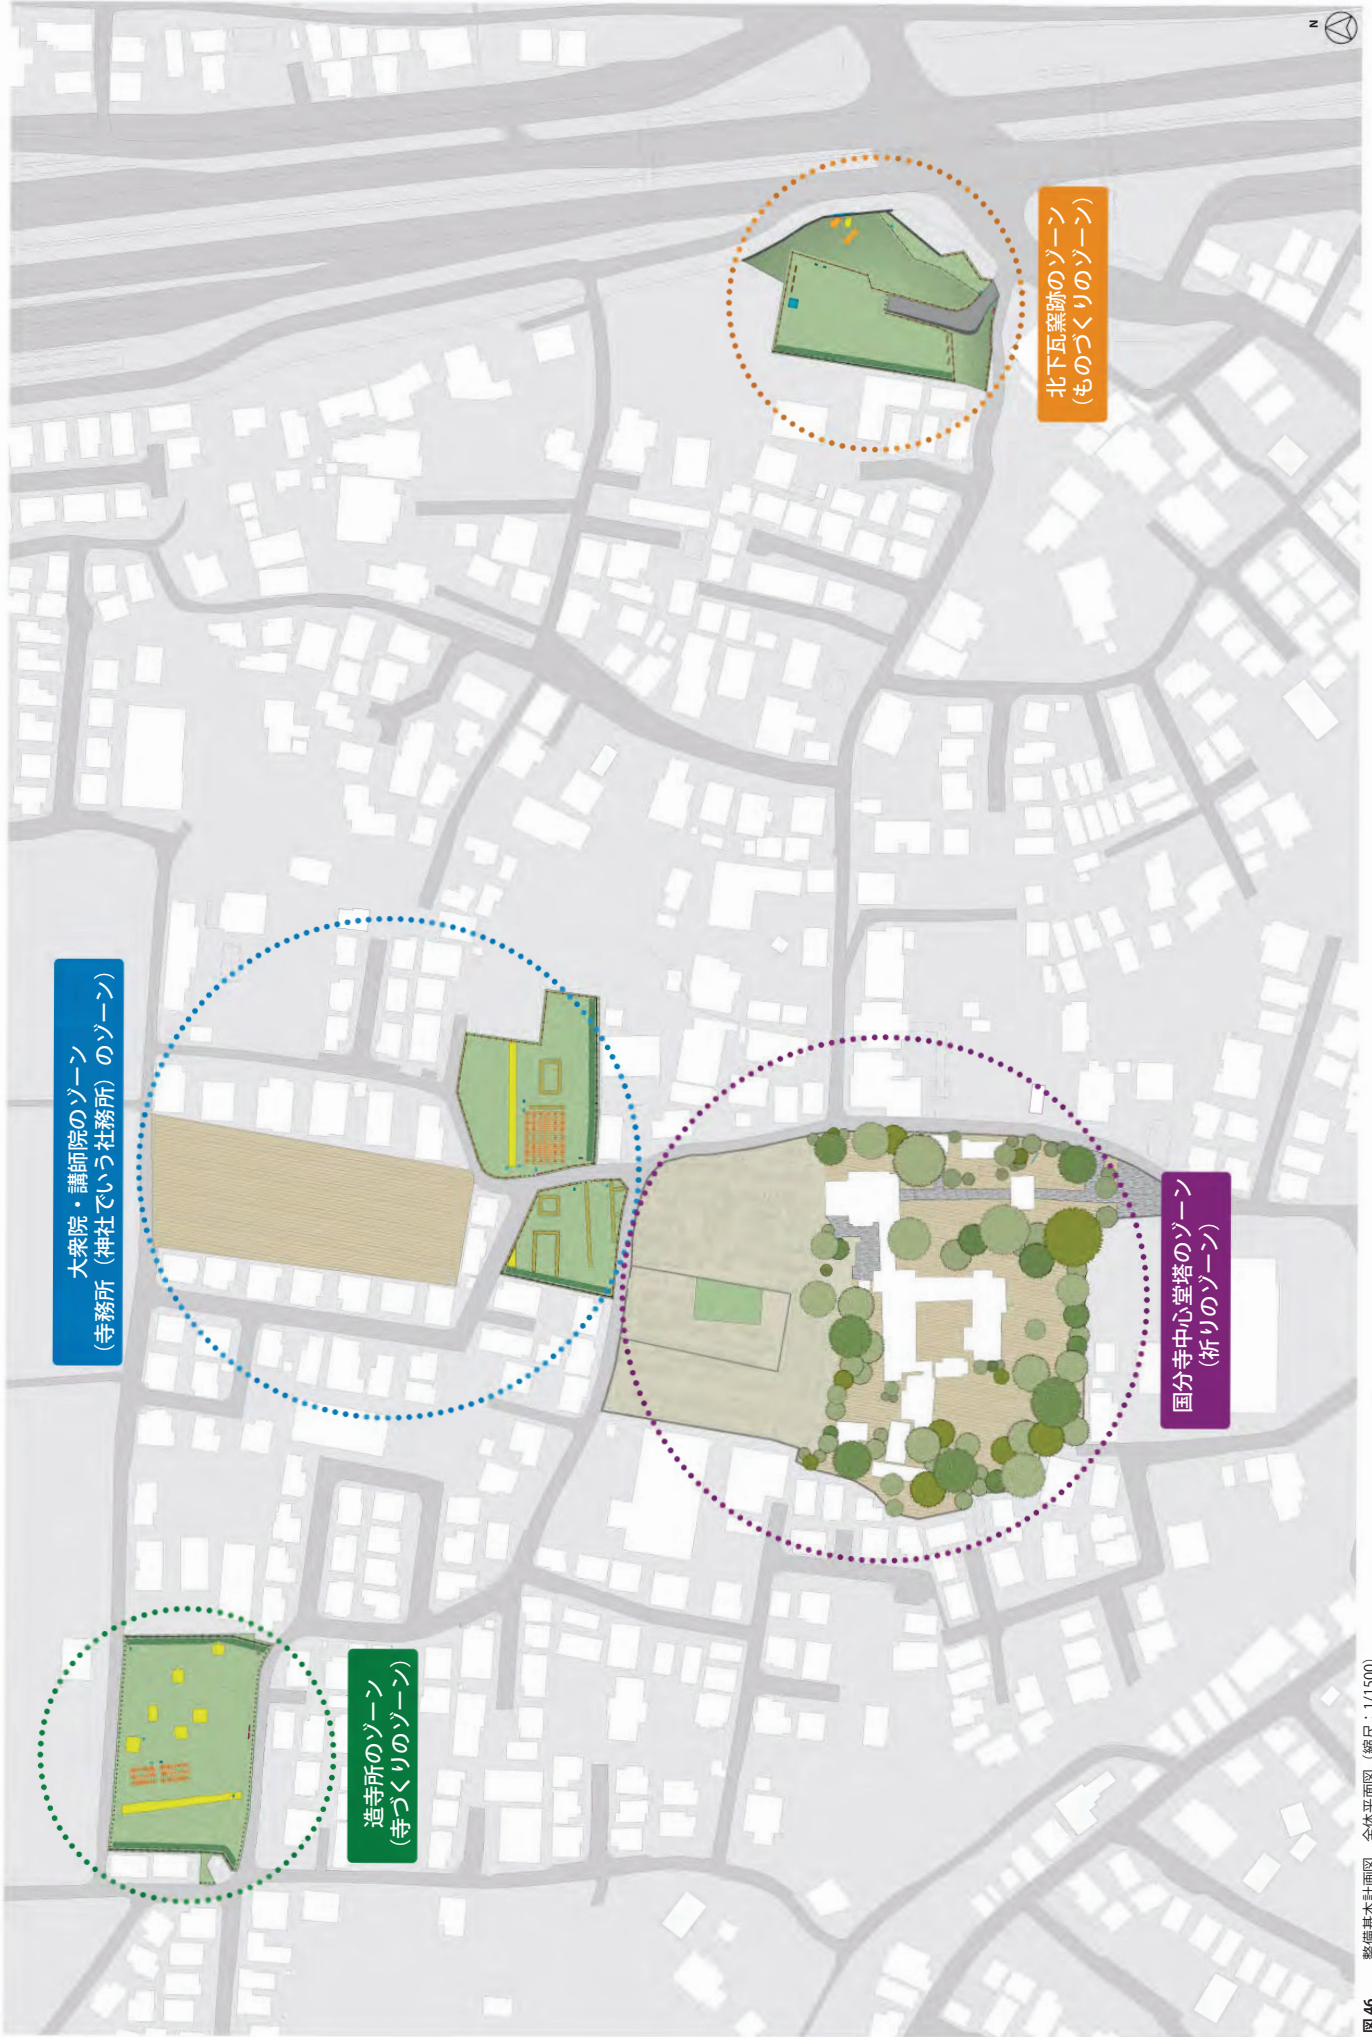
整備基本計画図 全体平面図 (縮尺：1/1500)
